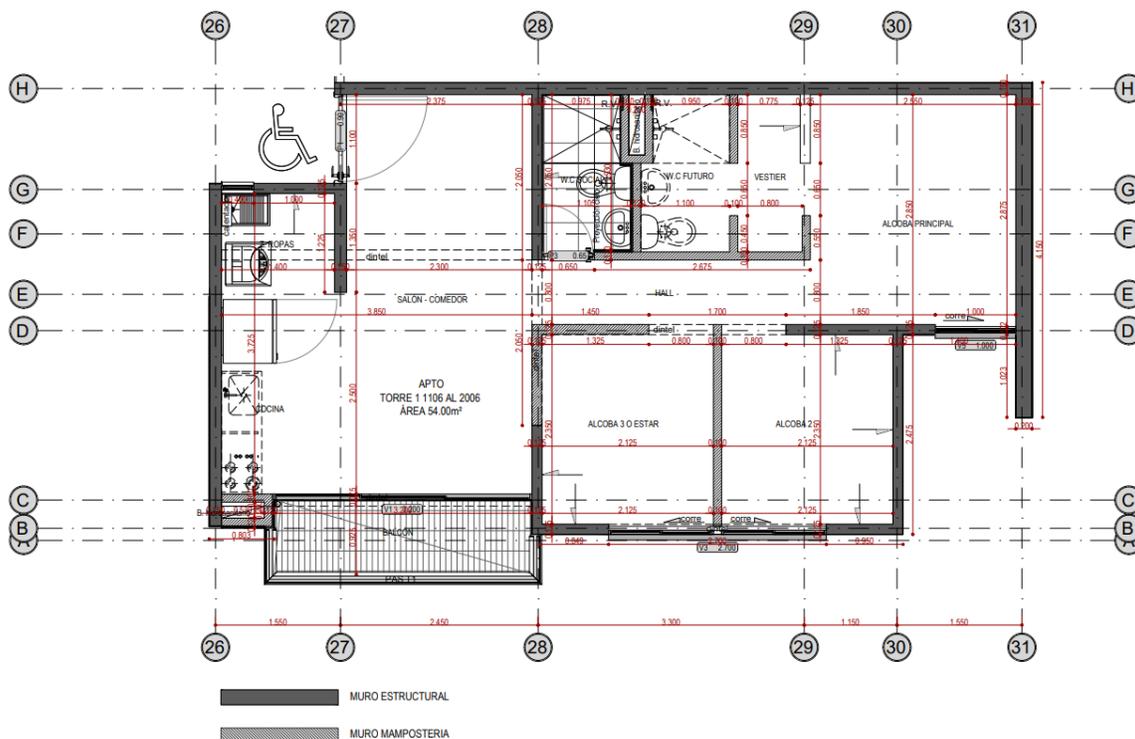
Planta arquitectónica Vivienda tipo VIS – Constructora de la Región.
